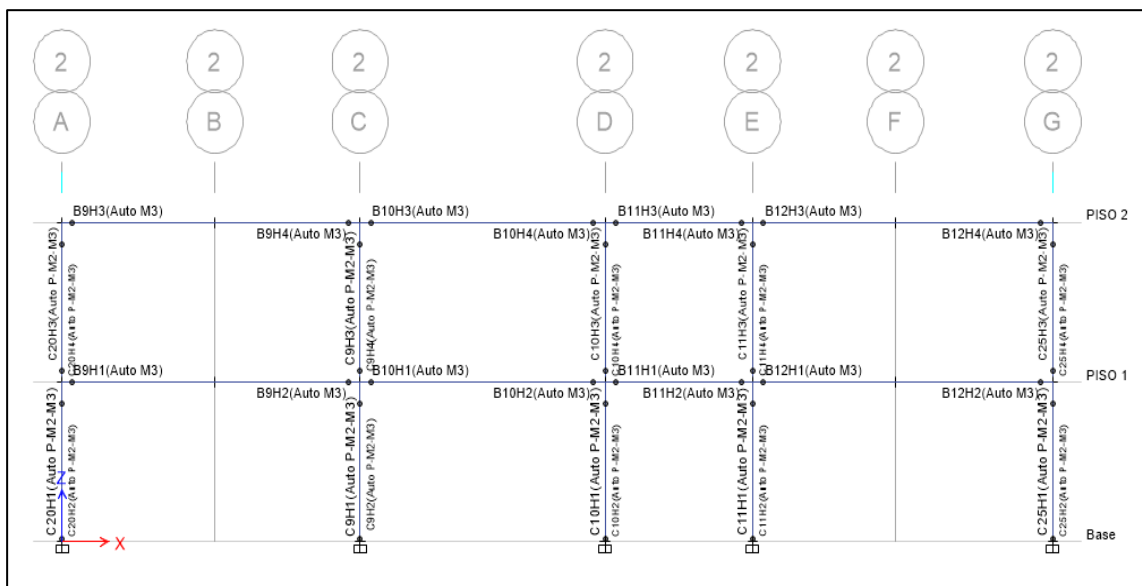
Ubicación de las rótulas plásticas en las vigas en el eje x-x. Fuente: Elaboración propia.
